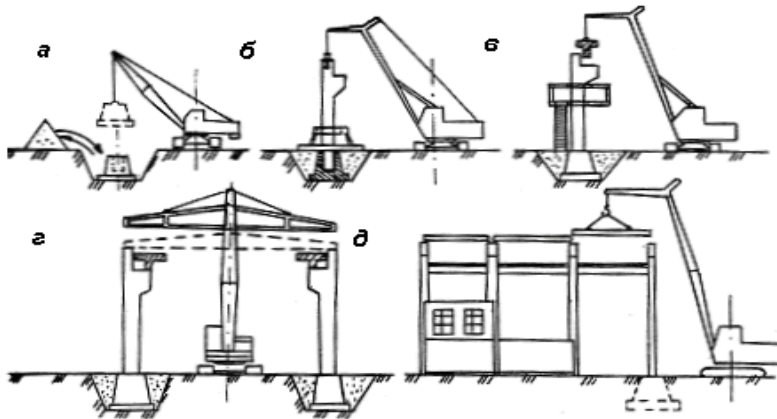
Схеми елементного монтажу: а – фундаментних блоків; б – колон; в – підкранових балок; г – ферм; д – плит перекриття
